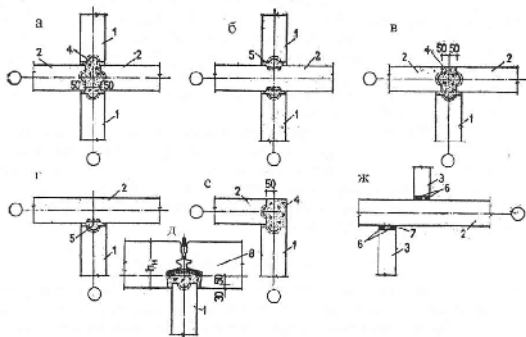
Вертикальные стыки бетонных панелей внутренних стен и перегородок: а - е - стыки несущих панелей между собой и с наружной стеной, ж - стык ненесущих перегородок со стеновой панелью; 1 и 2 - панели поперечных и продольных внутренних стен; 3 - панель перегородки; 4 - бетон замонolithicивания; 5 - сплошные рифления стыковых граней панелей; 6 - упругие прокладки; 7 - цементно - песчаный раствор; 8 - панель наружной стены
